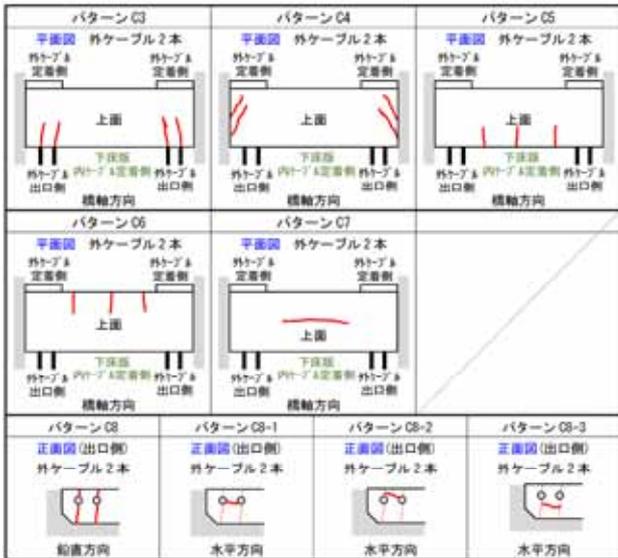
ひび割れパターン(外ケーブル定着部)
